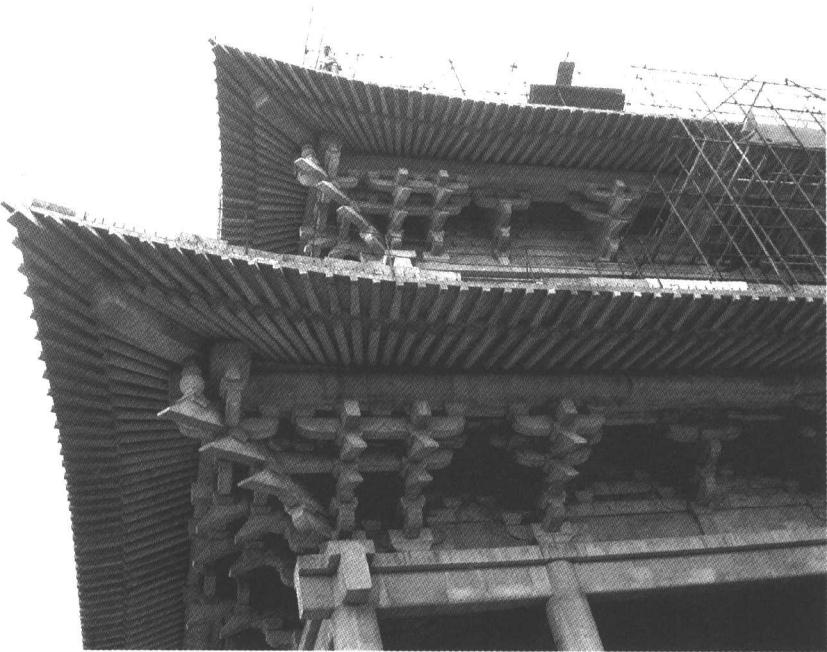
钢筋混凝土外飞檐及翼角翘飞
